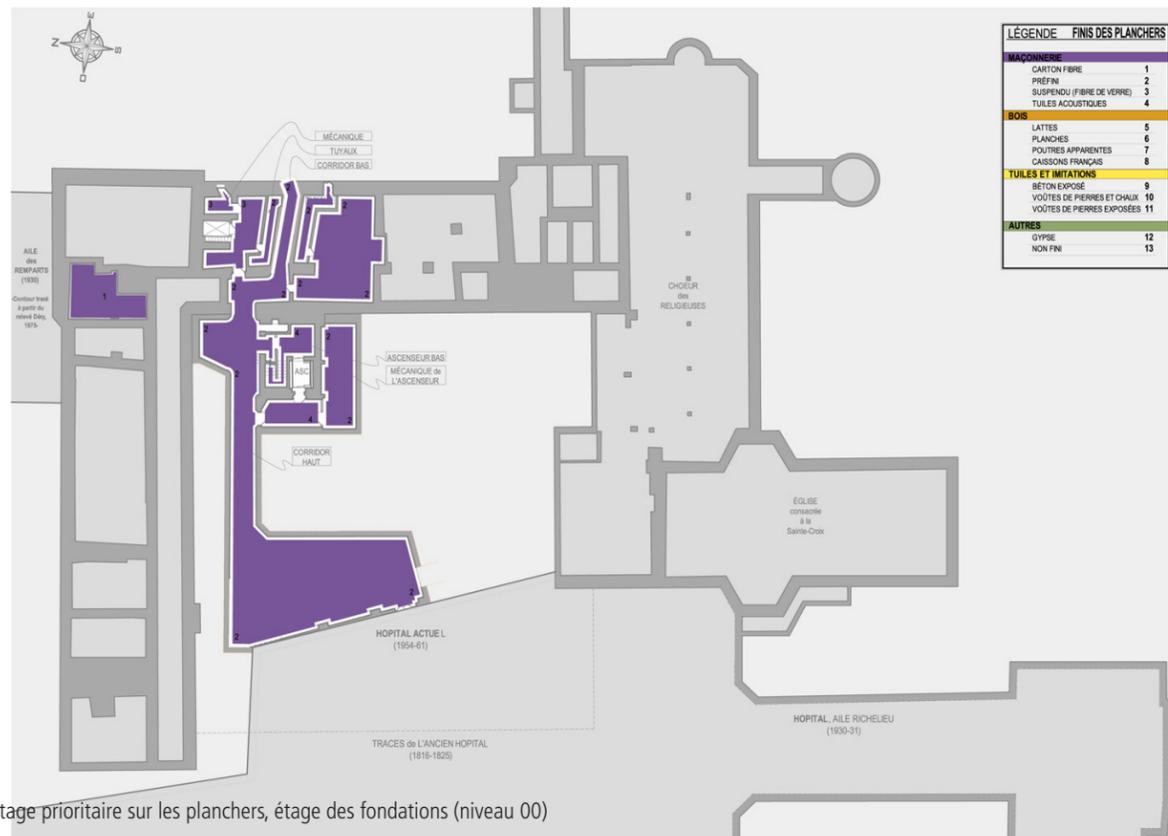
Plan de curetage prioritaire sur les planchers, étage des fondations (niveau 00)
